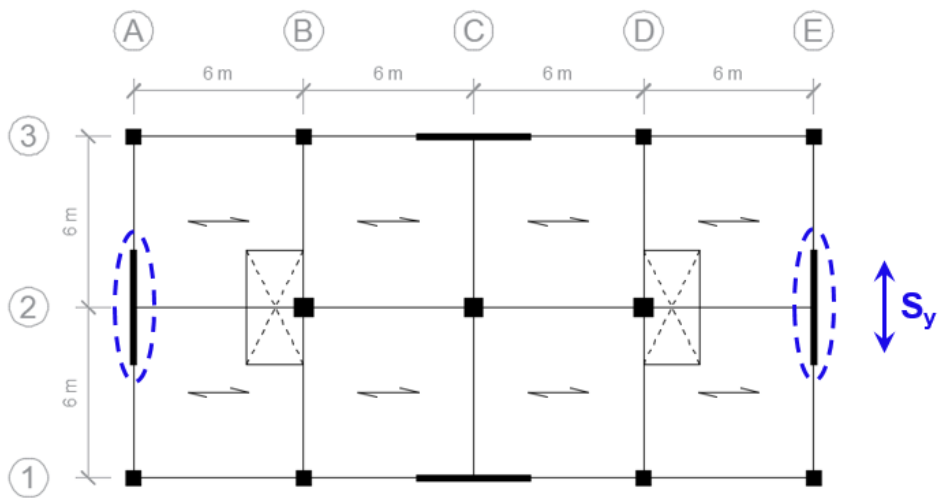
Ubicación de la conexión losa - muro estructural, para la fuerza sísmica en la dirección Y
